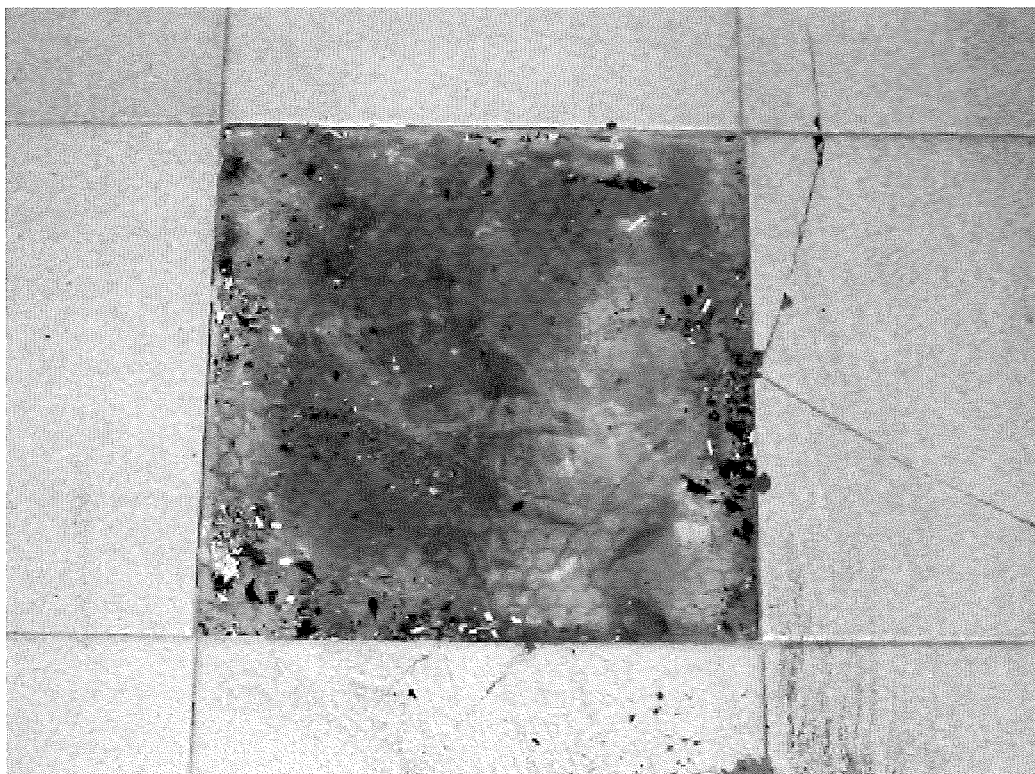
Fisuración de un pavimento, colocado con adhesivo, por retracción de la capa de mortero inferior (obsérvese que dicha capa también está fisurada).
